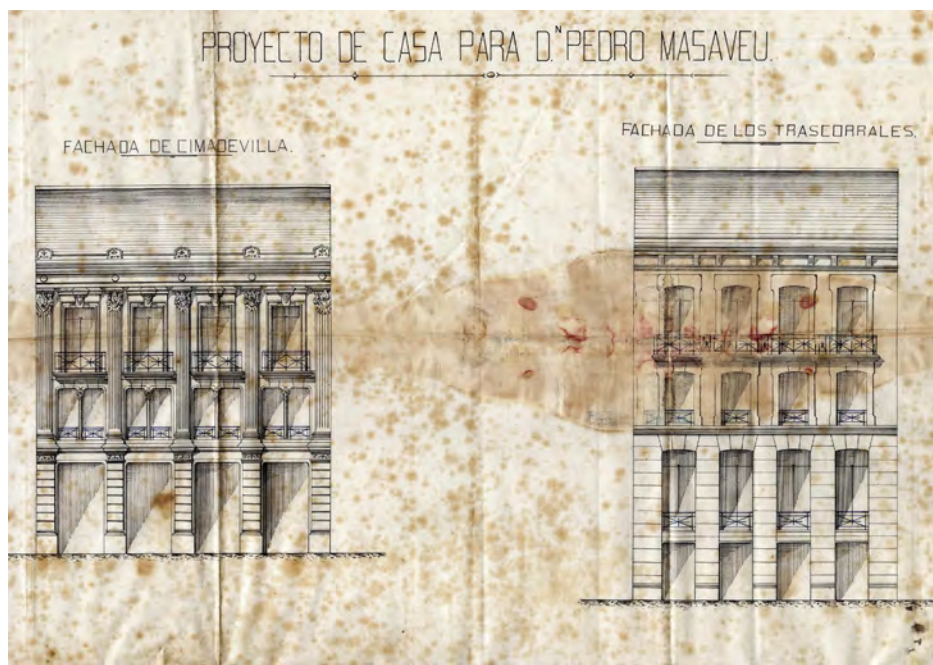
Alzado de las fachadas de la Casa Masaveu diseñadas por el arquitecto Javier Aguirre, 1885. AMO, Expte. 1,1,15,47.
